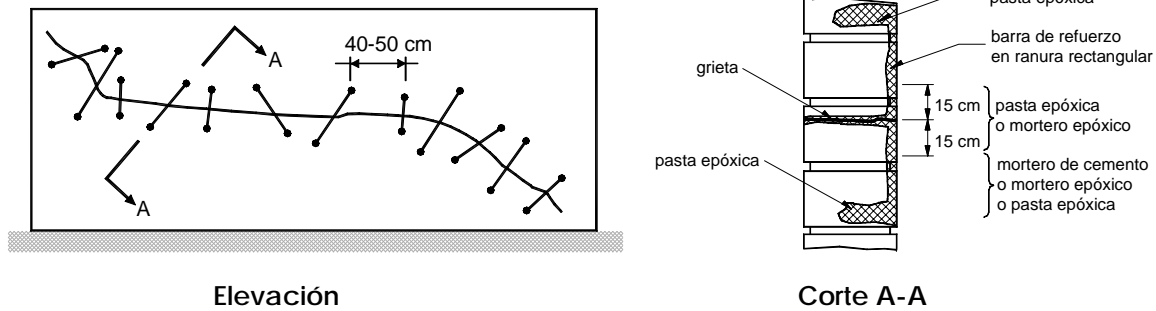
Colocación de grapas sobre grietas en muros de mampostería
